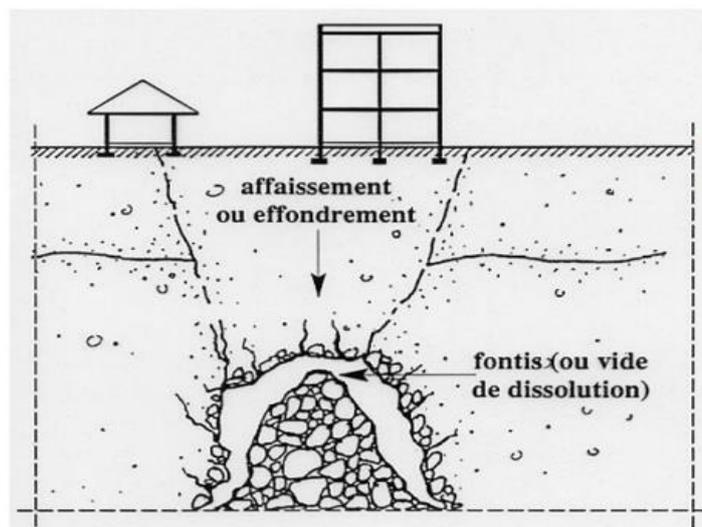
Tassement différentiel des fondations- terrain instable.
